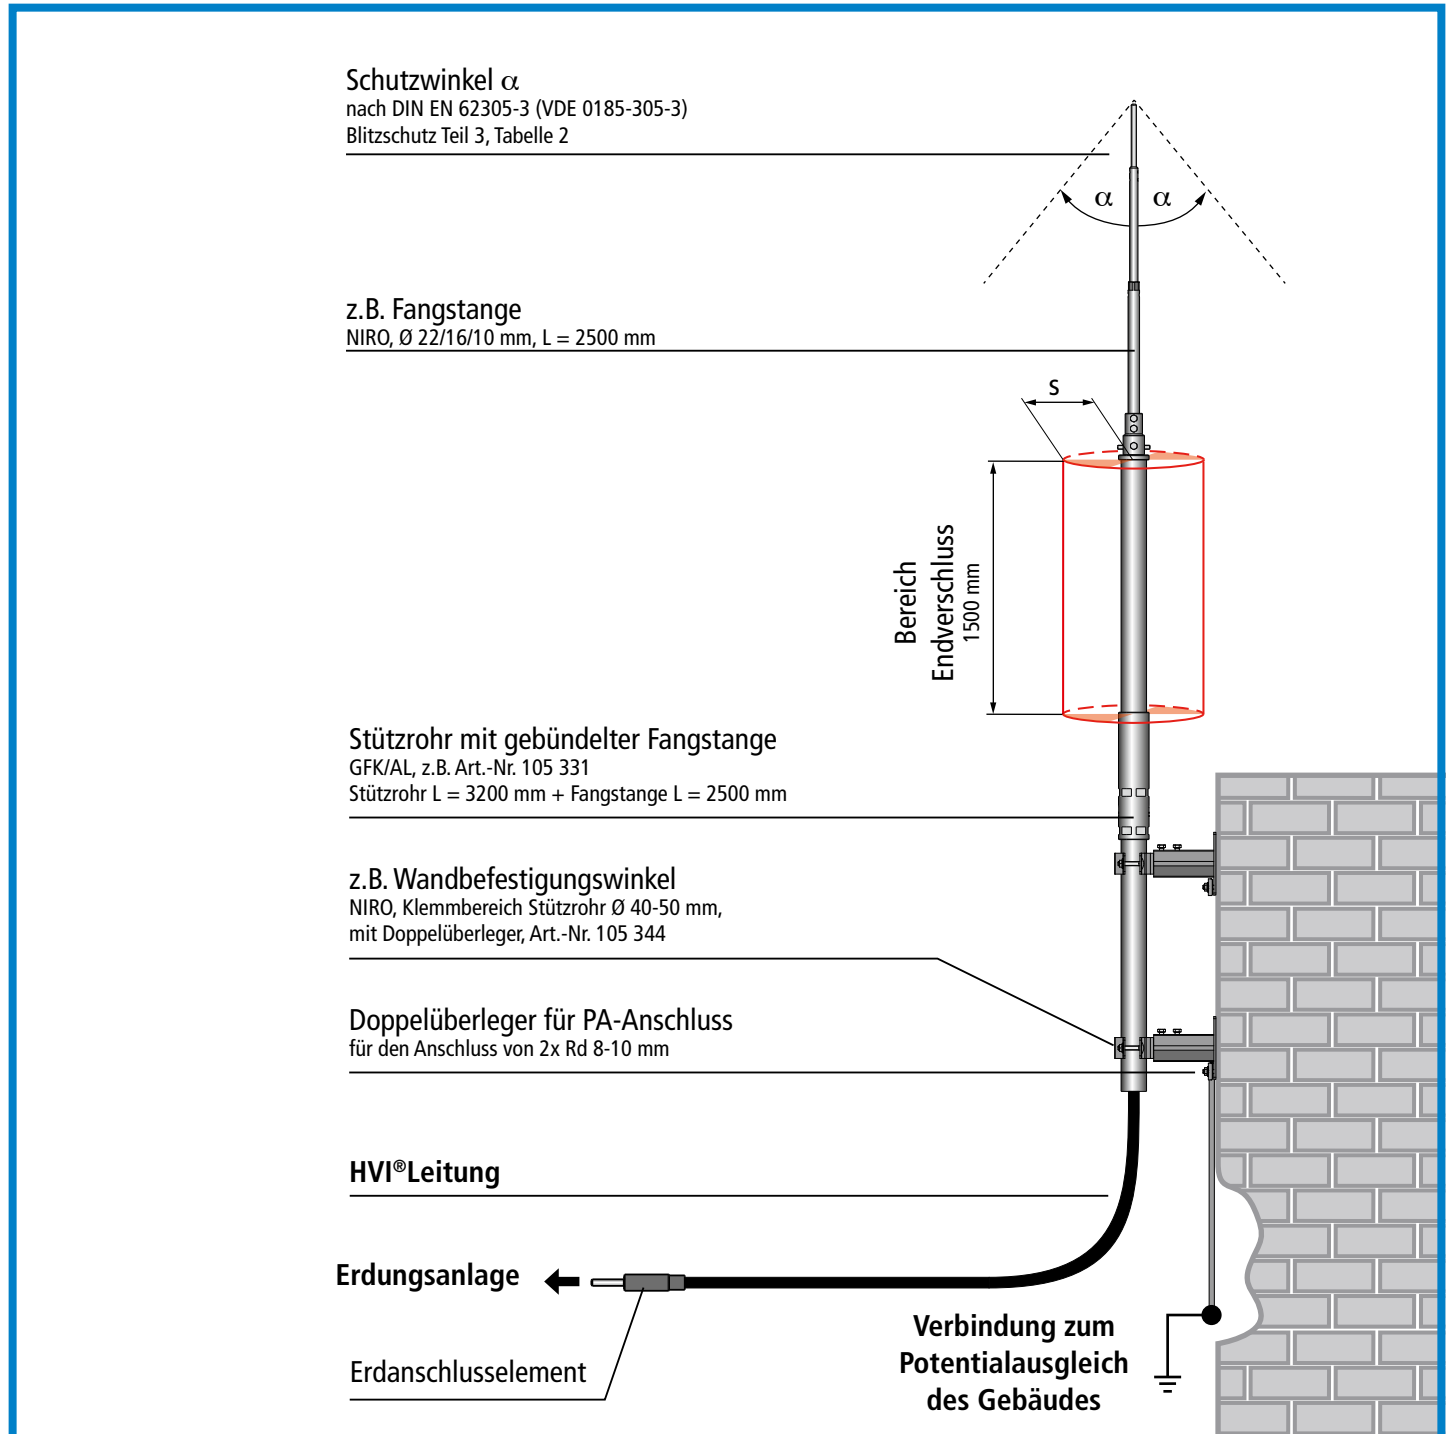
Getrennte Fangeinrichtung mit HVI®Leitung und Wandhalterung
